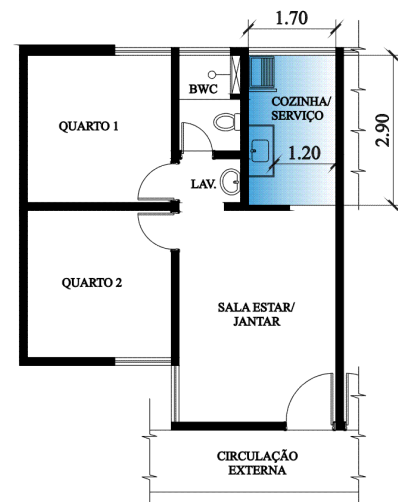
Planta Baixa Pav. Tipo: Setor de Serviço do Residencial Galápagos (sem escala)
